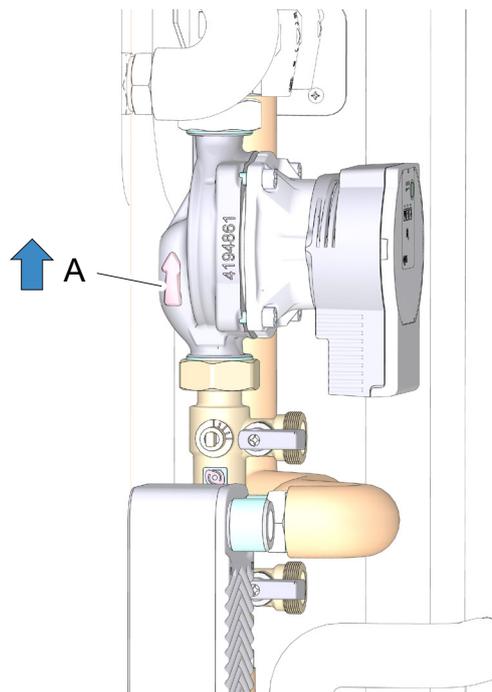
Detail Montage Umwälzpumpe Sonnenkollektor
